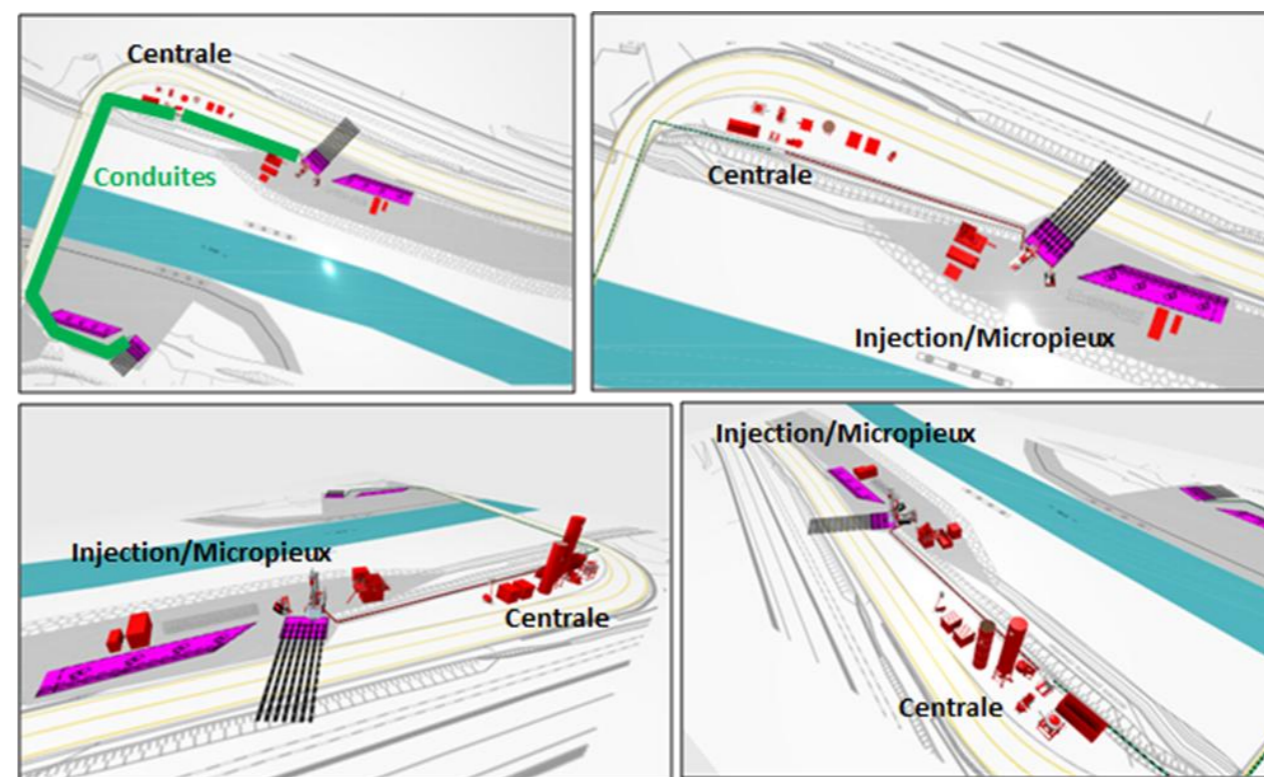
Plan d'installation de l'atelier d'injection/micropieux rive gauche
